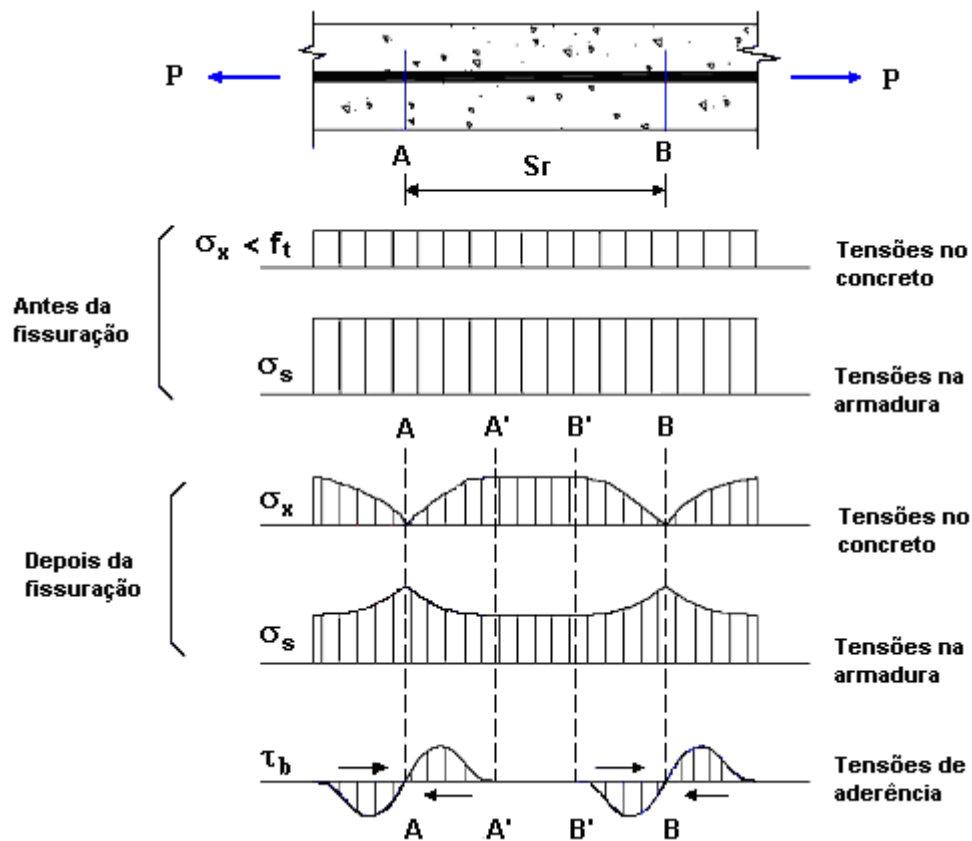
Fissuração por Tração [adaptada de Fusco, 1995].
